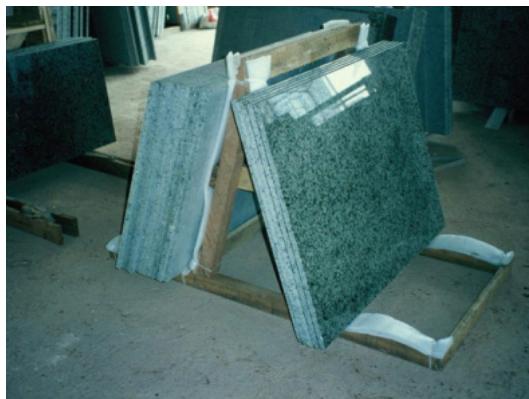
Exemplo de peças corretamente armazenadas em obra, sobre cavalete de madeira revestido com material impermeável.
